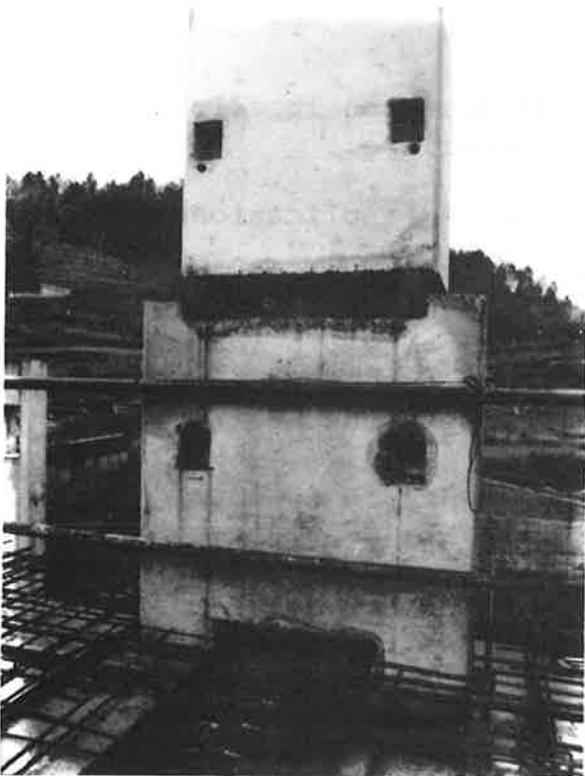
Giunzione in acciaio pre-sollecitato di un pilastro prima della iniezione dei tiranti.
